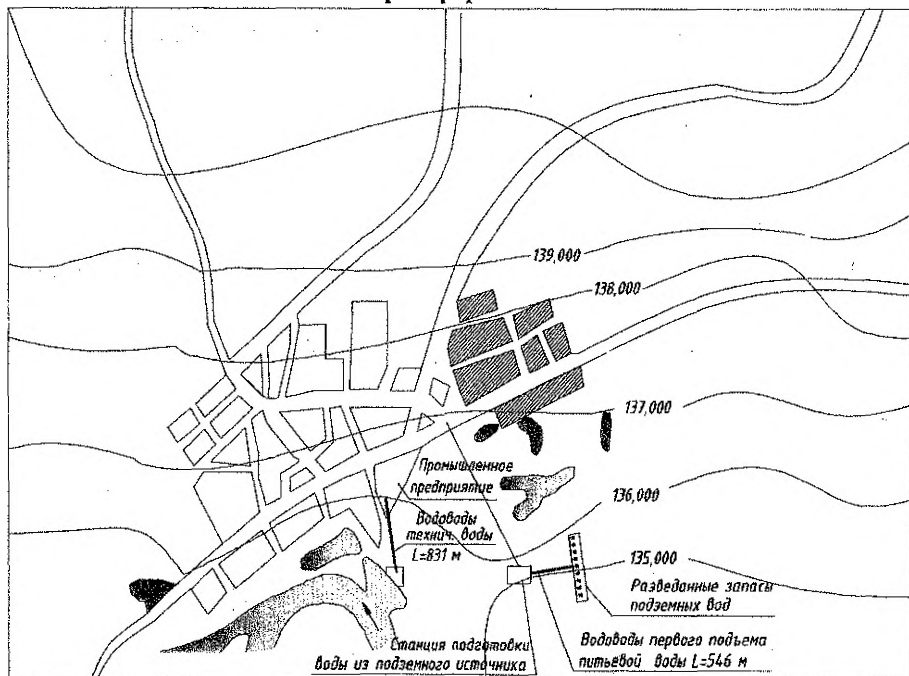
Ситуационный план водозаборных сооружений из поверхностного и подземного источников водоснабжения
